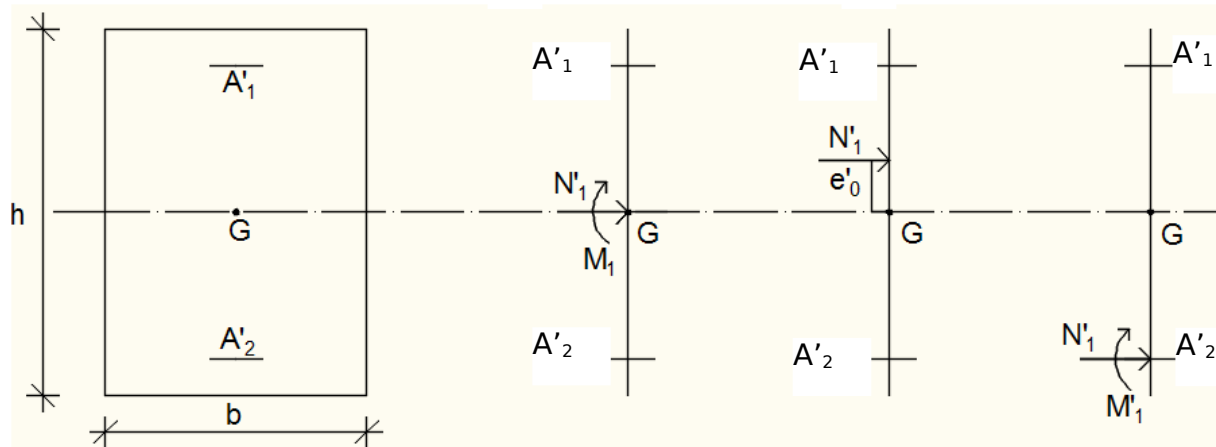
Position de N'_1 , M'_1 et M_1 sur la section transversale.
